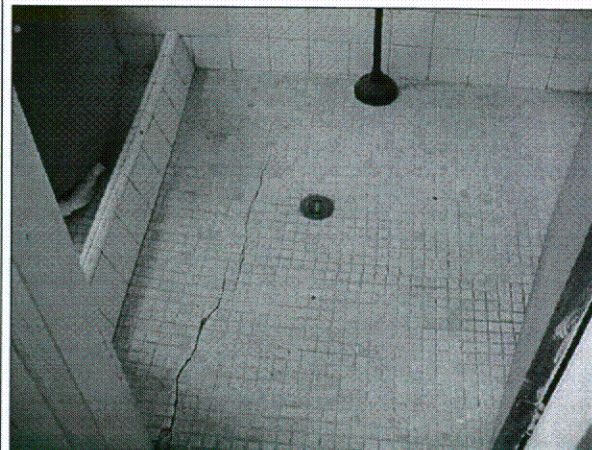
Grietas en el piso de un baño, ubicado en el cuarto piso, costado oriental del edificio de salones de clase.
